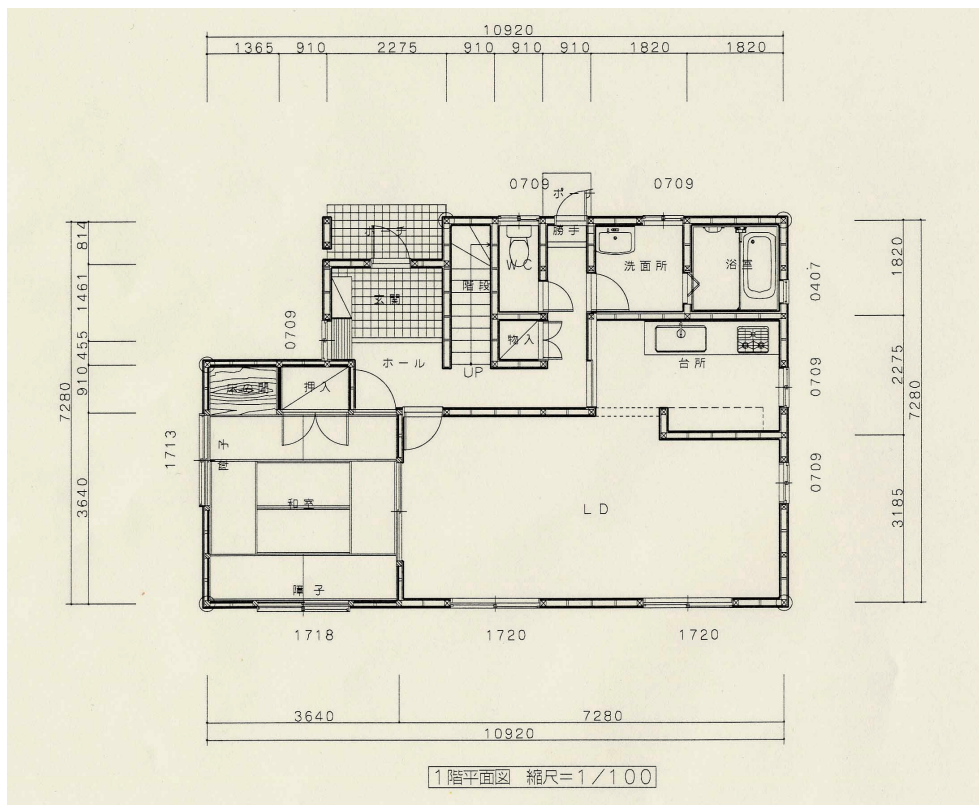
公庫標準仕様モデル図面 1 階平面図
